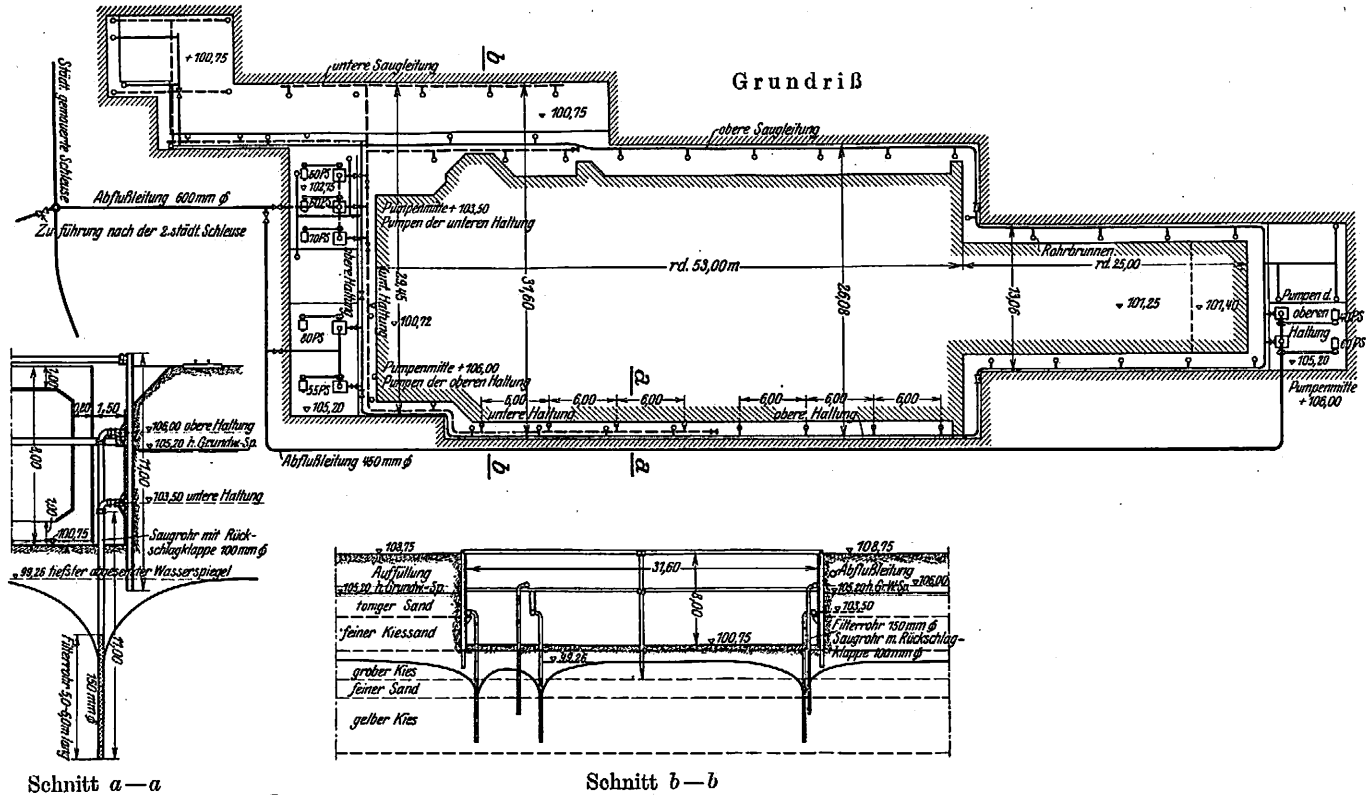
Grundwasser-Senkungsanlage für den Bau der Untergrundbahn im Bereich des Hauptbahnhofs Leipzig.
